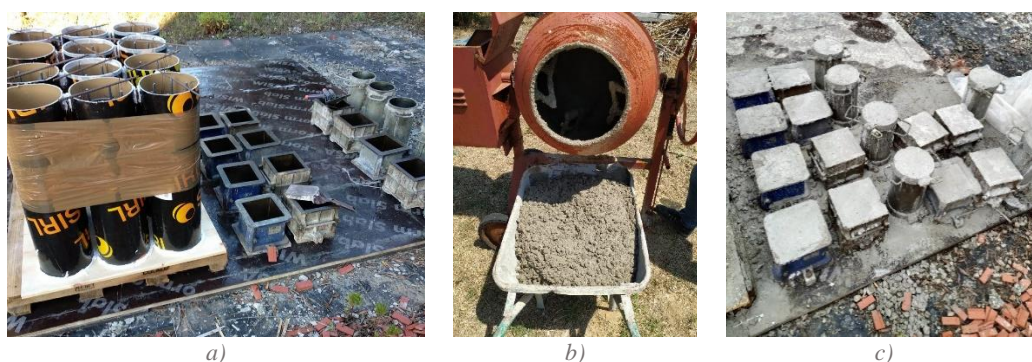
Betonagem: a) disposição inicial; b) betonagem indireta com recurso a carrinho de mão e c) resultado da betonagem
